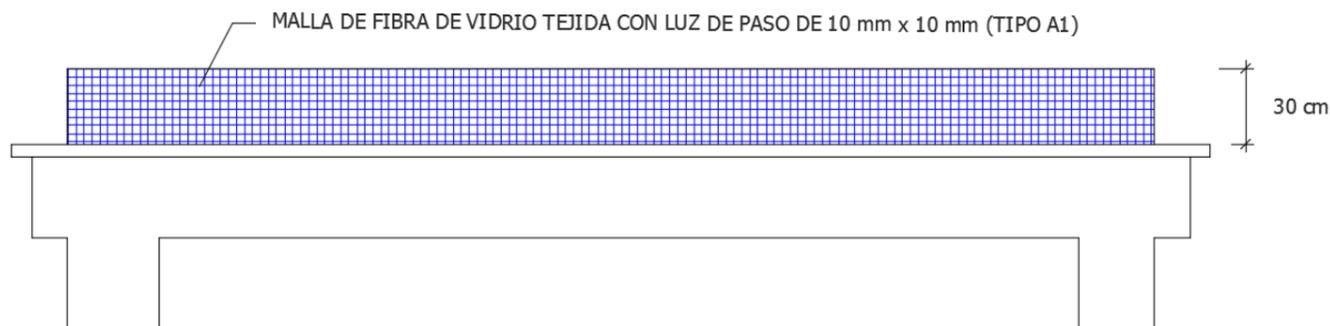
Detalle alzado casetón cubierta. 2018. Elaboración propia
